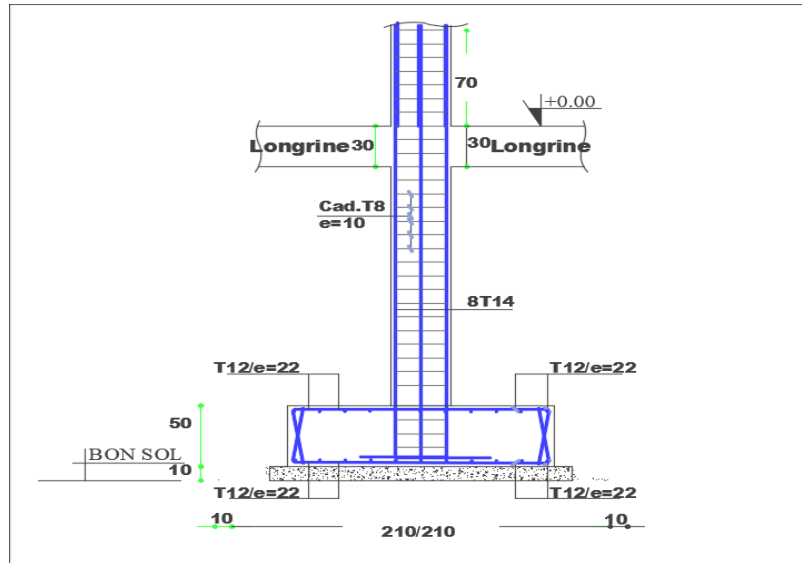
Schéma des Ferrailage de la semelle isolée.
